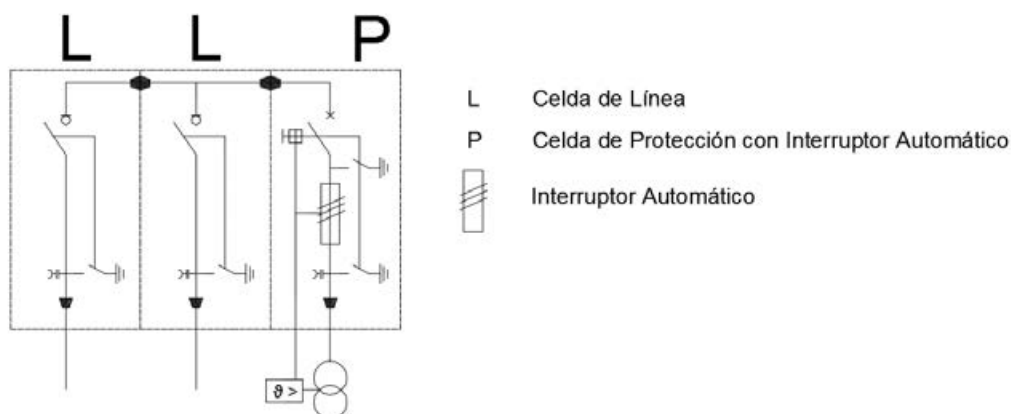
Doc. II. Cálculos - Protecciones Centro de Seccionamiento.
